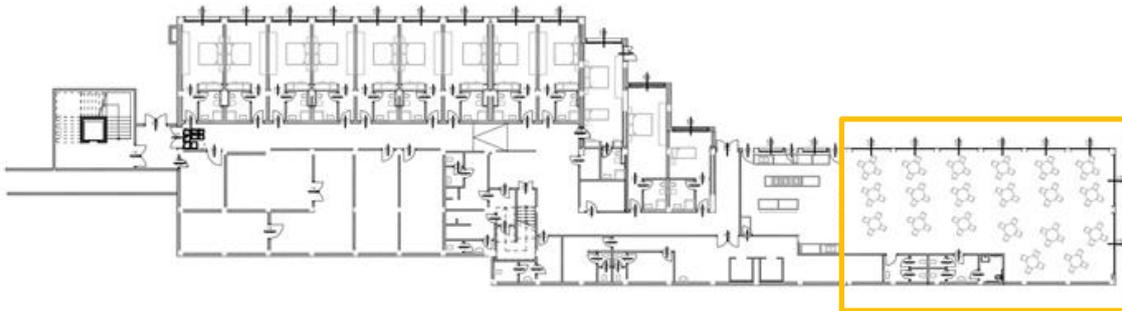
pianta del piano interrato dell'Hotel San Faustino. Evidenziato in arancione il ristorante
